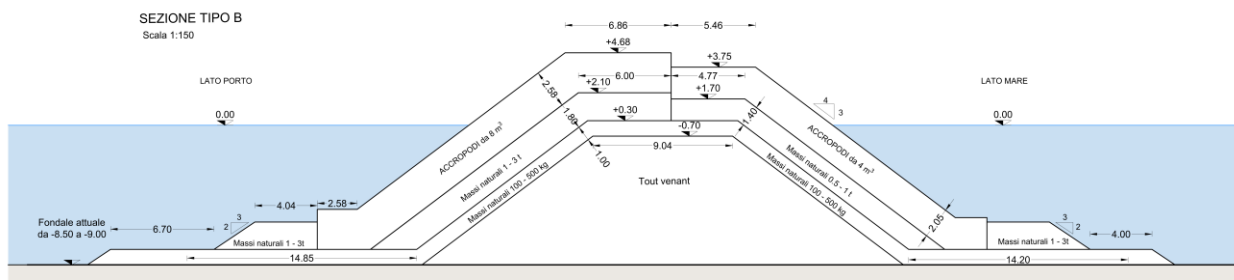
Sezione tipo B del Prolungamento della Diga Foranea Sud
